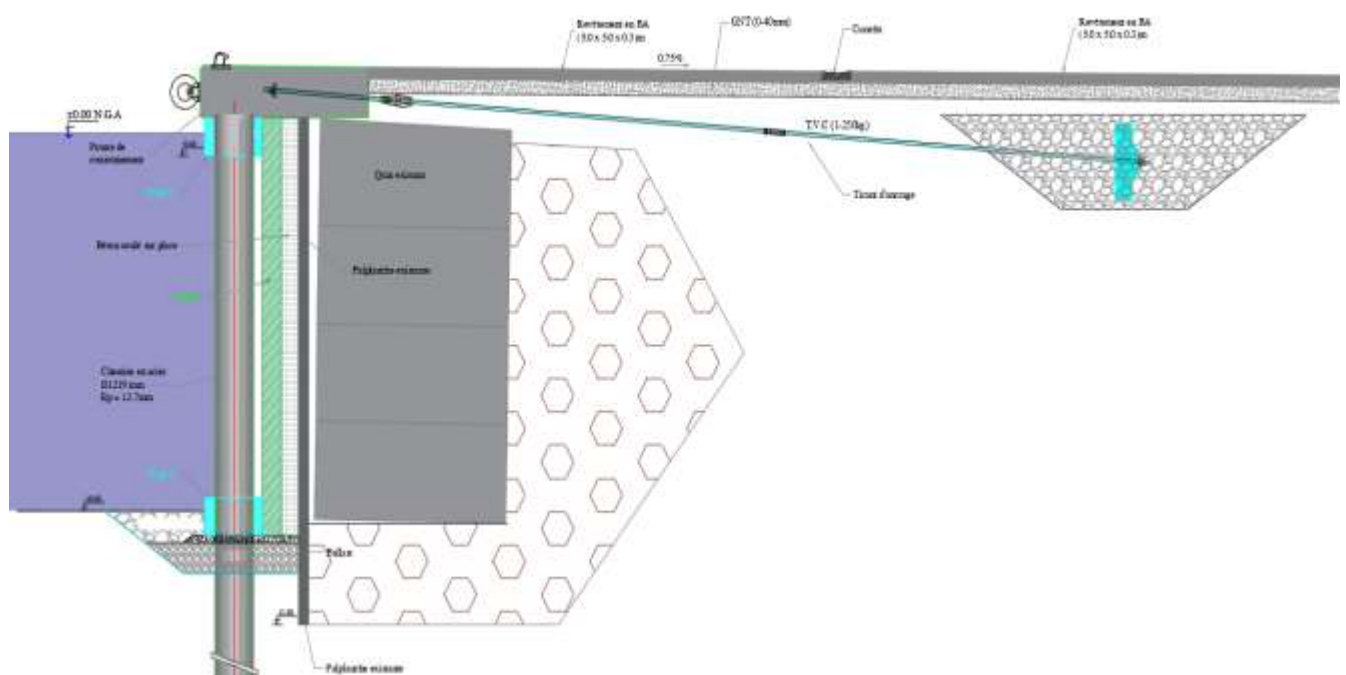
Coupe transversale du quai mixte (passe casbah)
